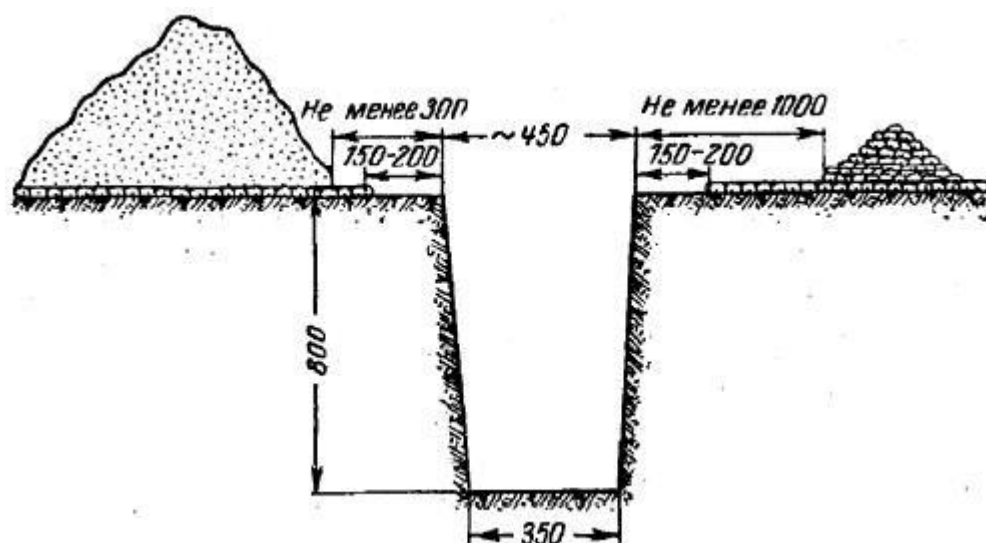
Схема размещения грунта около траншеи (Если не предписано его удаление с места проведения работ)
